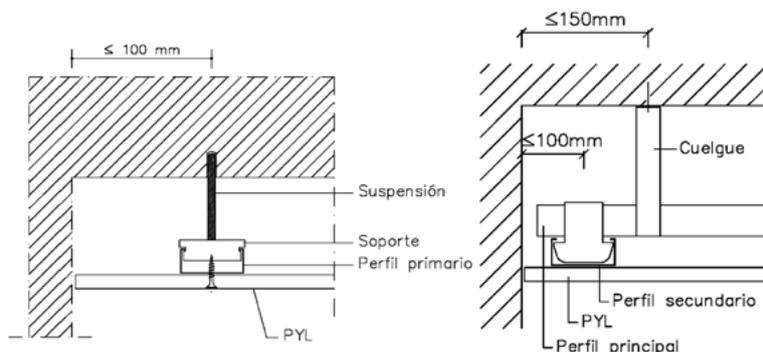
Situación de los cuelgues con perfil con una estructura o perfil secundario.
